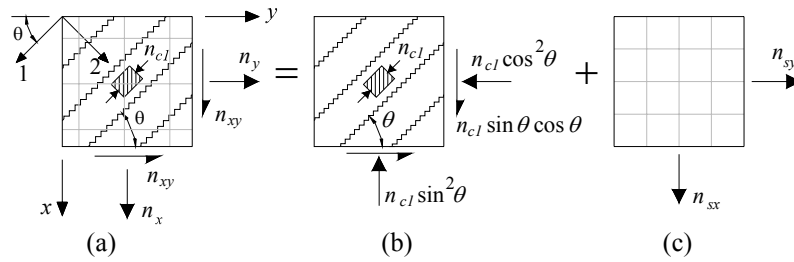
Elemento de betão armado submetido a EPT: a) forças aplicadas; esforços b) no betão c) nas armaduras.
